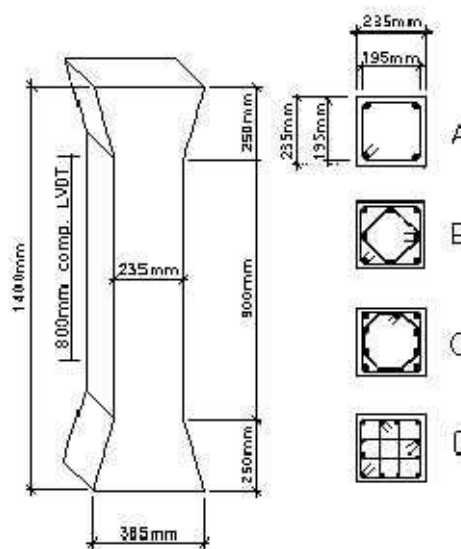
Pilares ensaiados por CUSSON & PAULTRE (1994)
